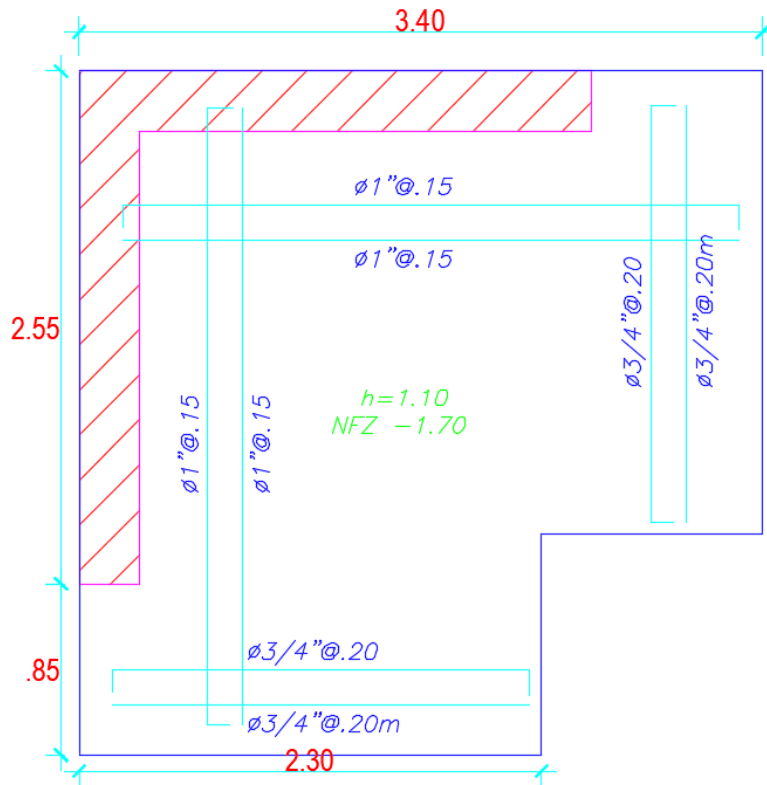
Detalle de refuerzo de acero en la zapata en planta.
